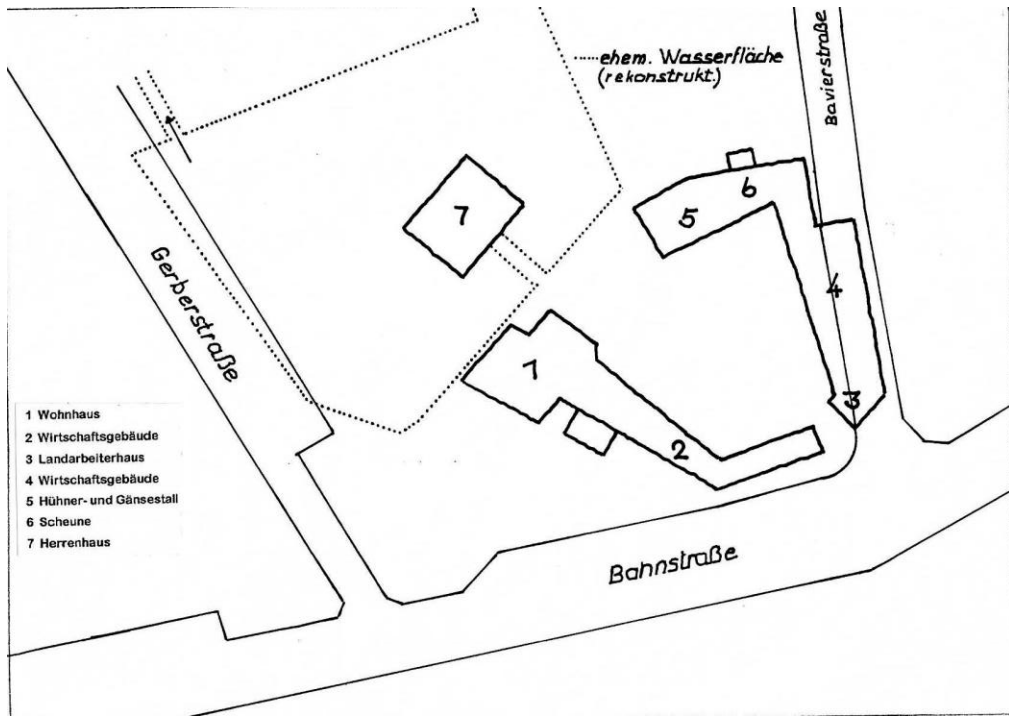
Lageplan Haus Bavier, erstellt von Hein Witte
